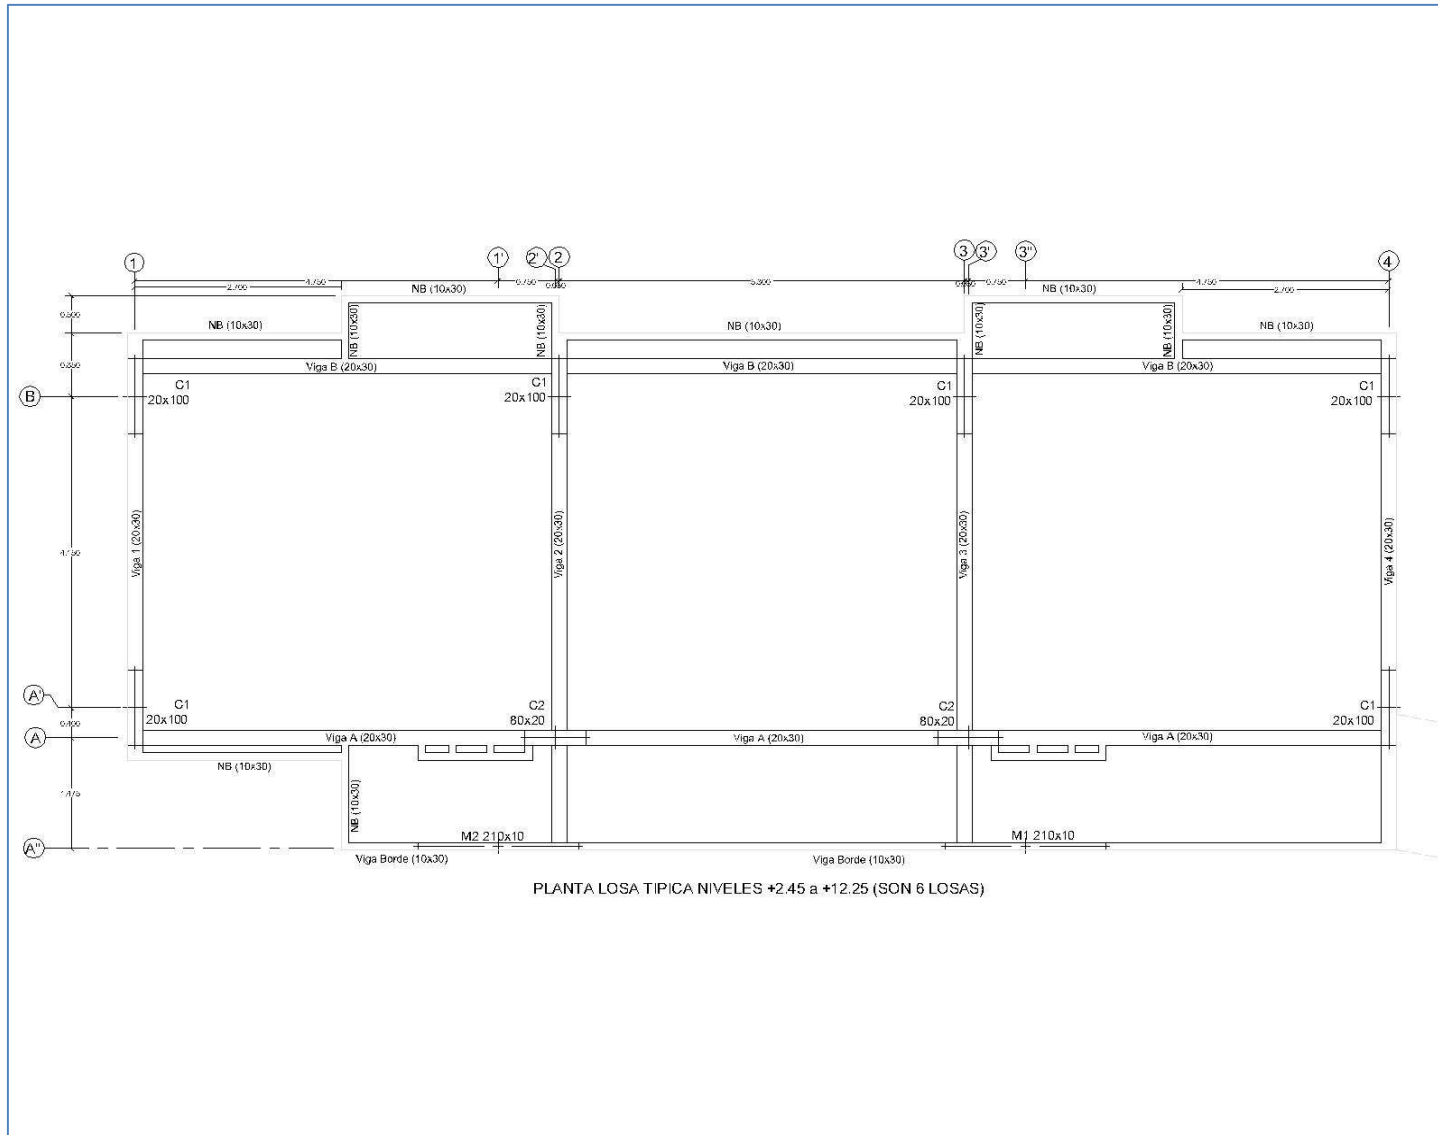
Planta losa típica obra La Herrera. (PORTICOS S.A.,2009)
